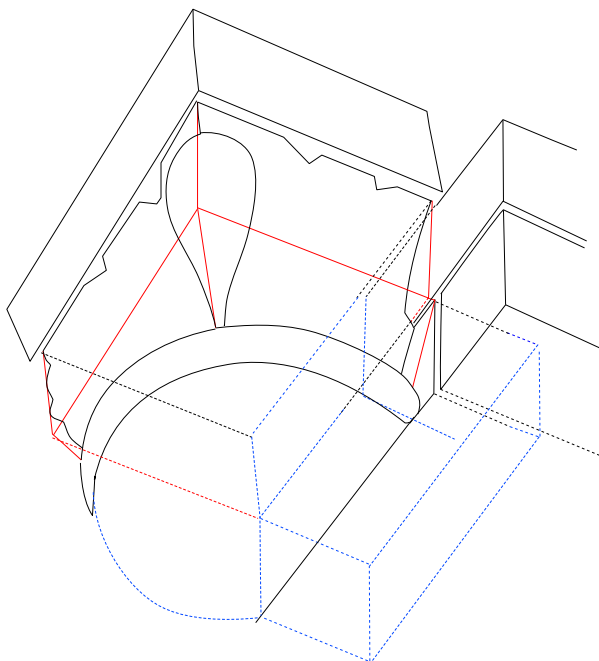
Encastrement d'un des chapiteaux de la croisée (n° 3).
